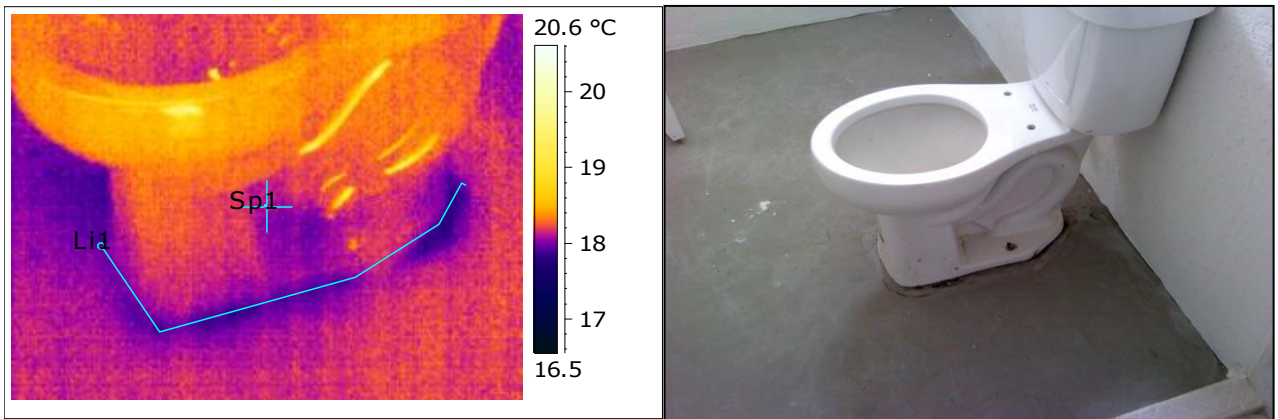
Aire de infiltración en la unión entre el WC y el suelo en vivienda de planta baja. Fuente propia.
